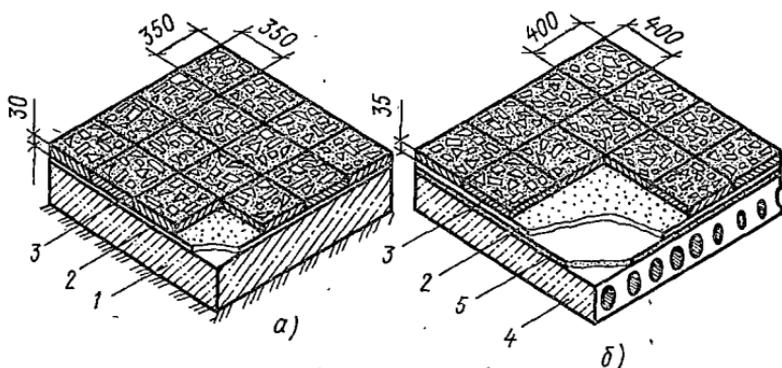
Полы из мозаично-бетонных плит, уложенных на грунте (а) и на междуэтажном перекрытии (б):
